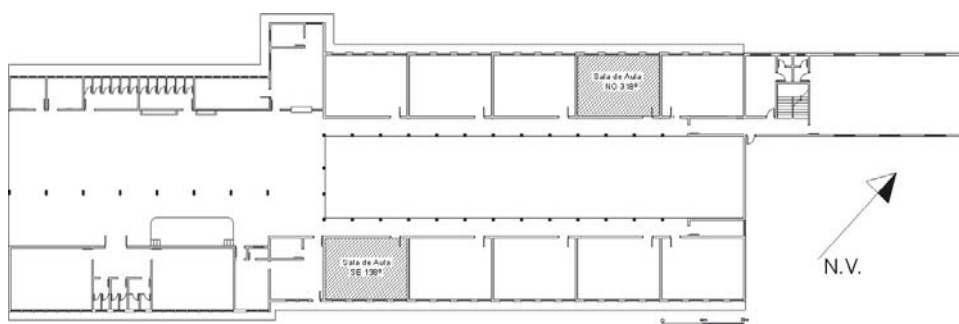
Planta baixa da EEB Max Tavares do Amaral com indicação das salas avaliadas
